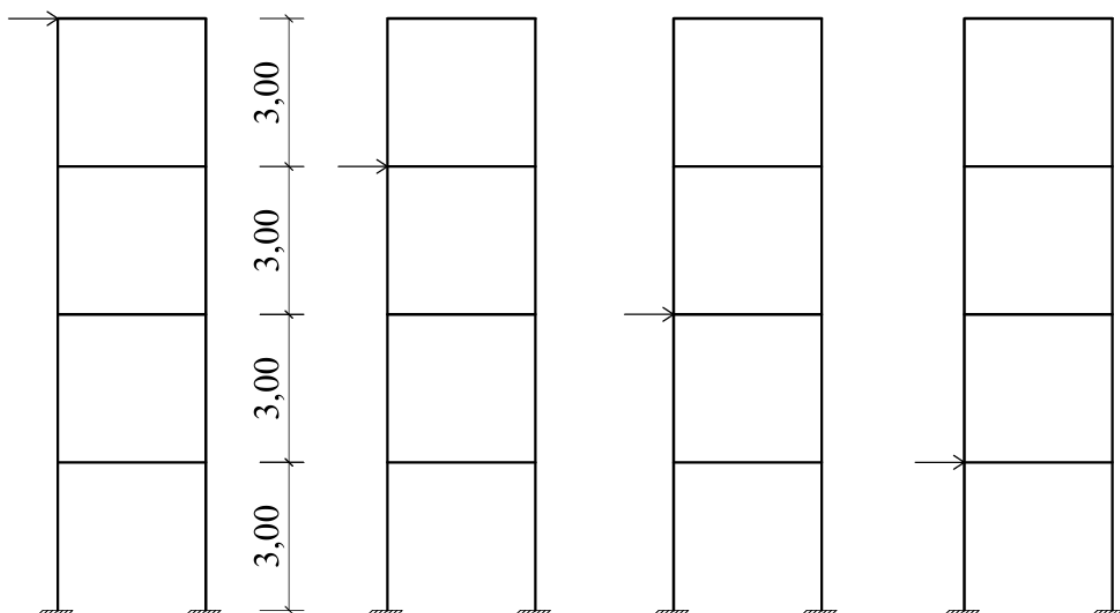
Rigidez Equivalente do pavimento considerando pórtico completo
